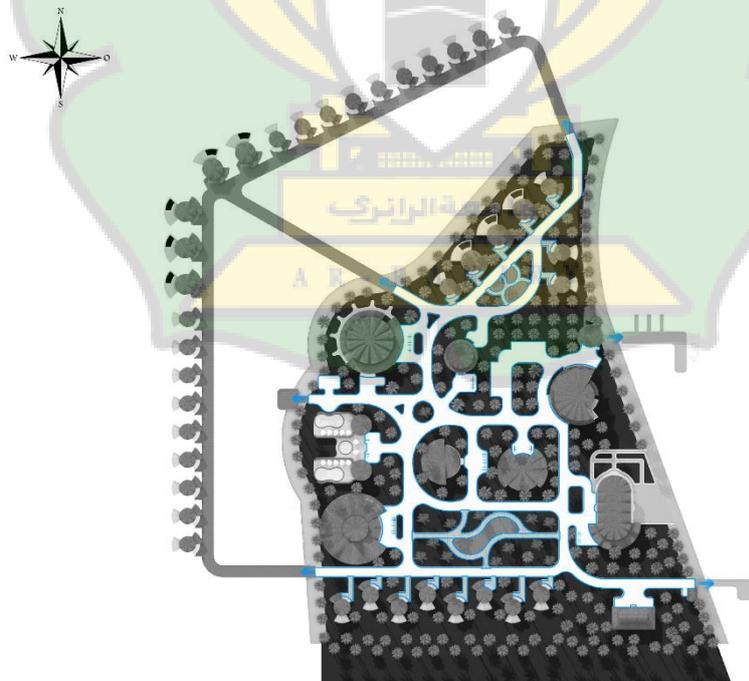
Rencana Instalasi *Black Water Deluxe Room
